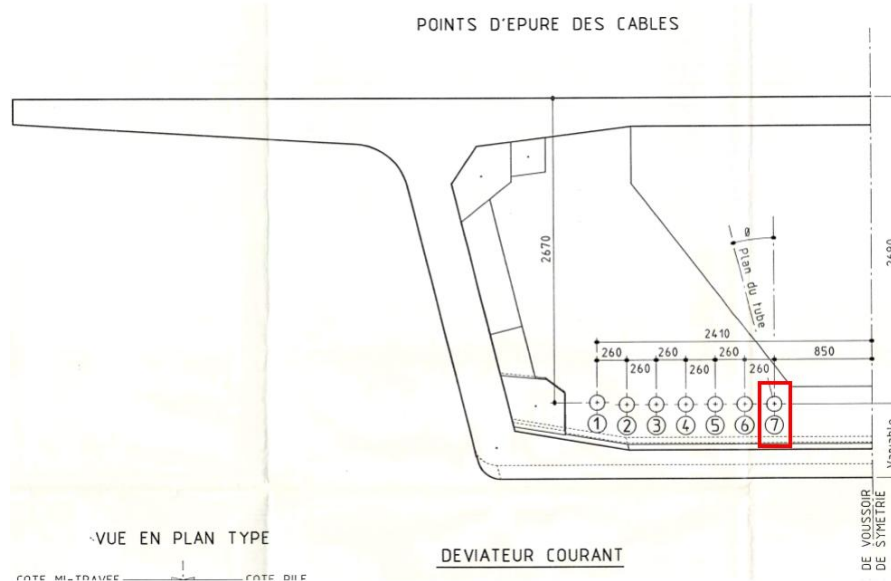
Position de passage du câble de précontrainte extérieure additionnelle au droit d'un voussoir déviateur (extrait plan P435)
